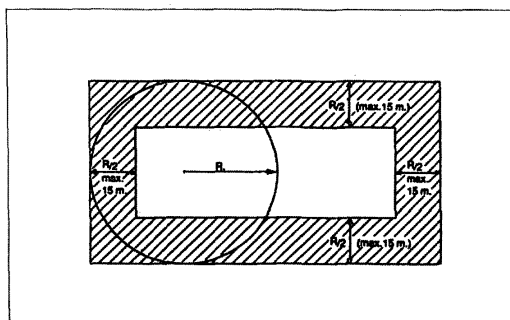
t/m 19, behorende bij de stedenbouwkundige bepalingen.
